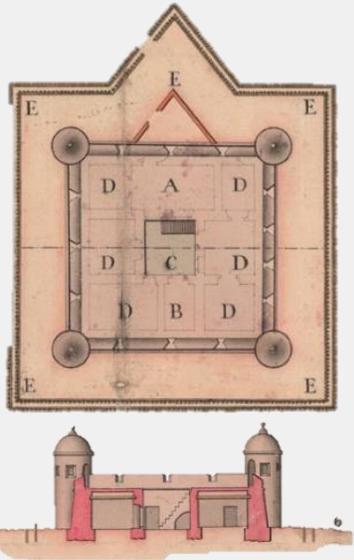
A.G.M.M. Sign: VEN-09-04. Segmento: Plano y perfil del fuerte de Zapas... A. Crame. 1778
